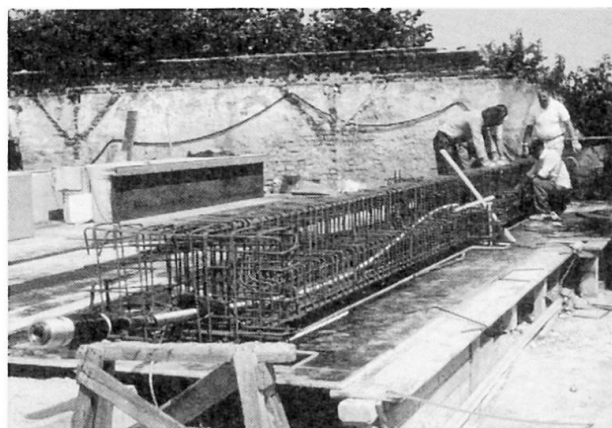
Neuer Fertigteilelbalken, Bewehrungskorb mit HLV-Spannglied
